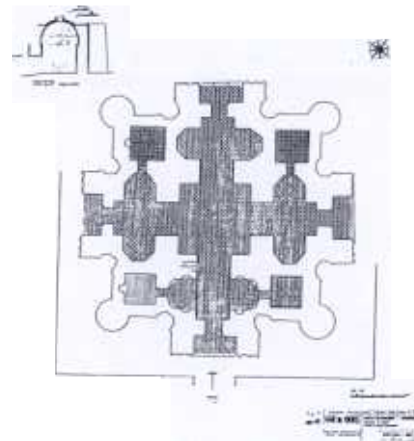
Afghanistan. Città di Ghazni. Moschea di Rauza. Pianta a quota pavimento.
